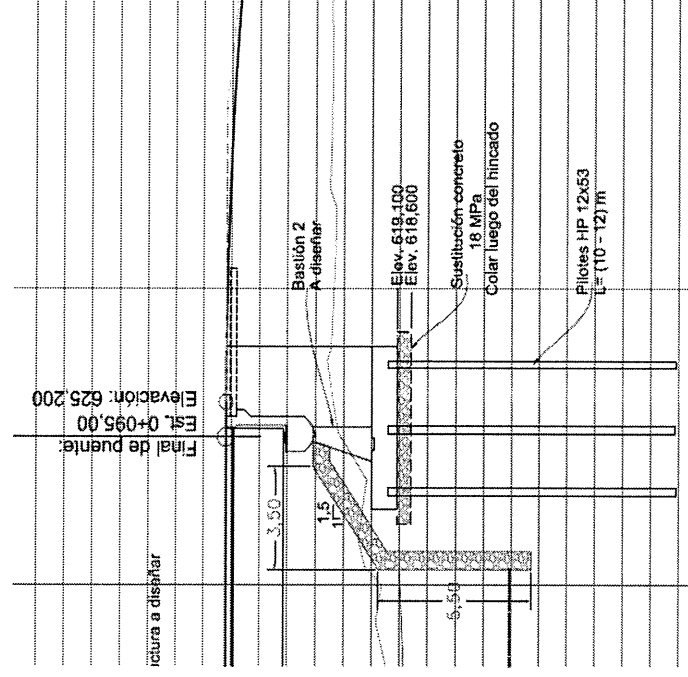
Detalle de pilotes recomendada en anteproyecto.
